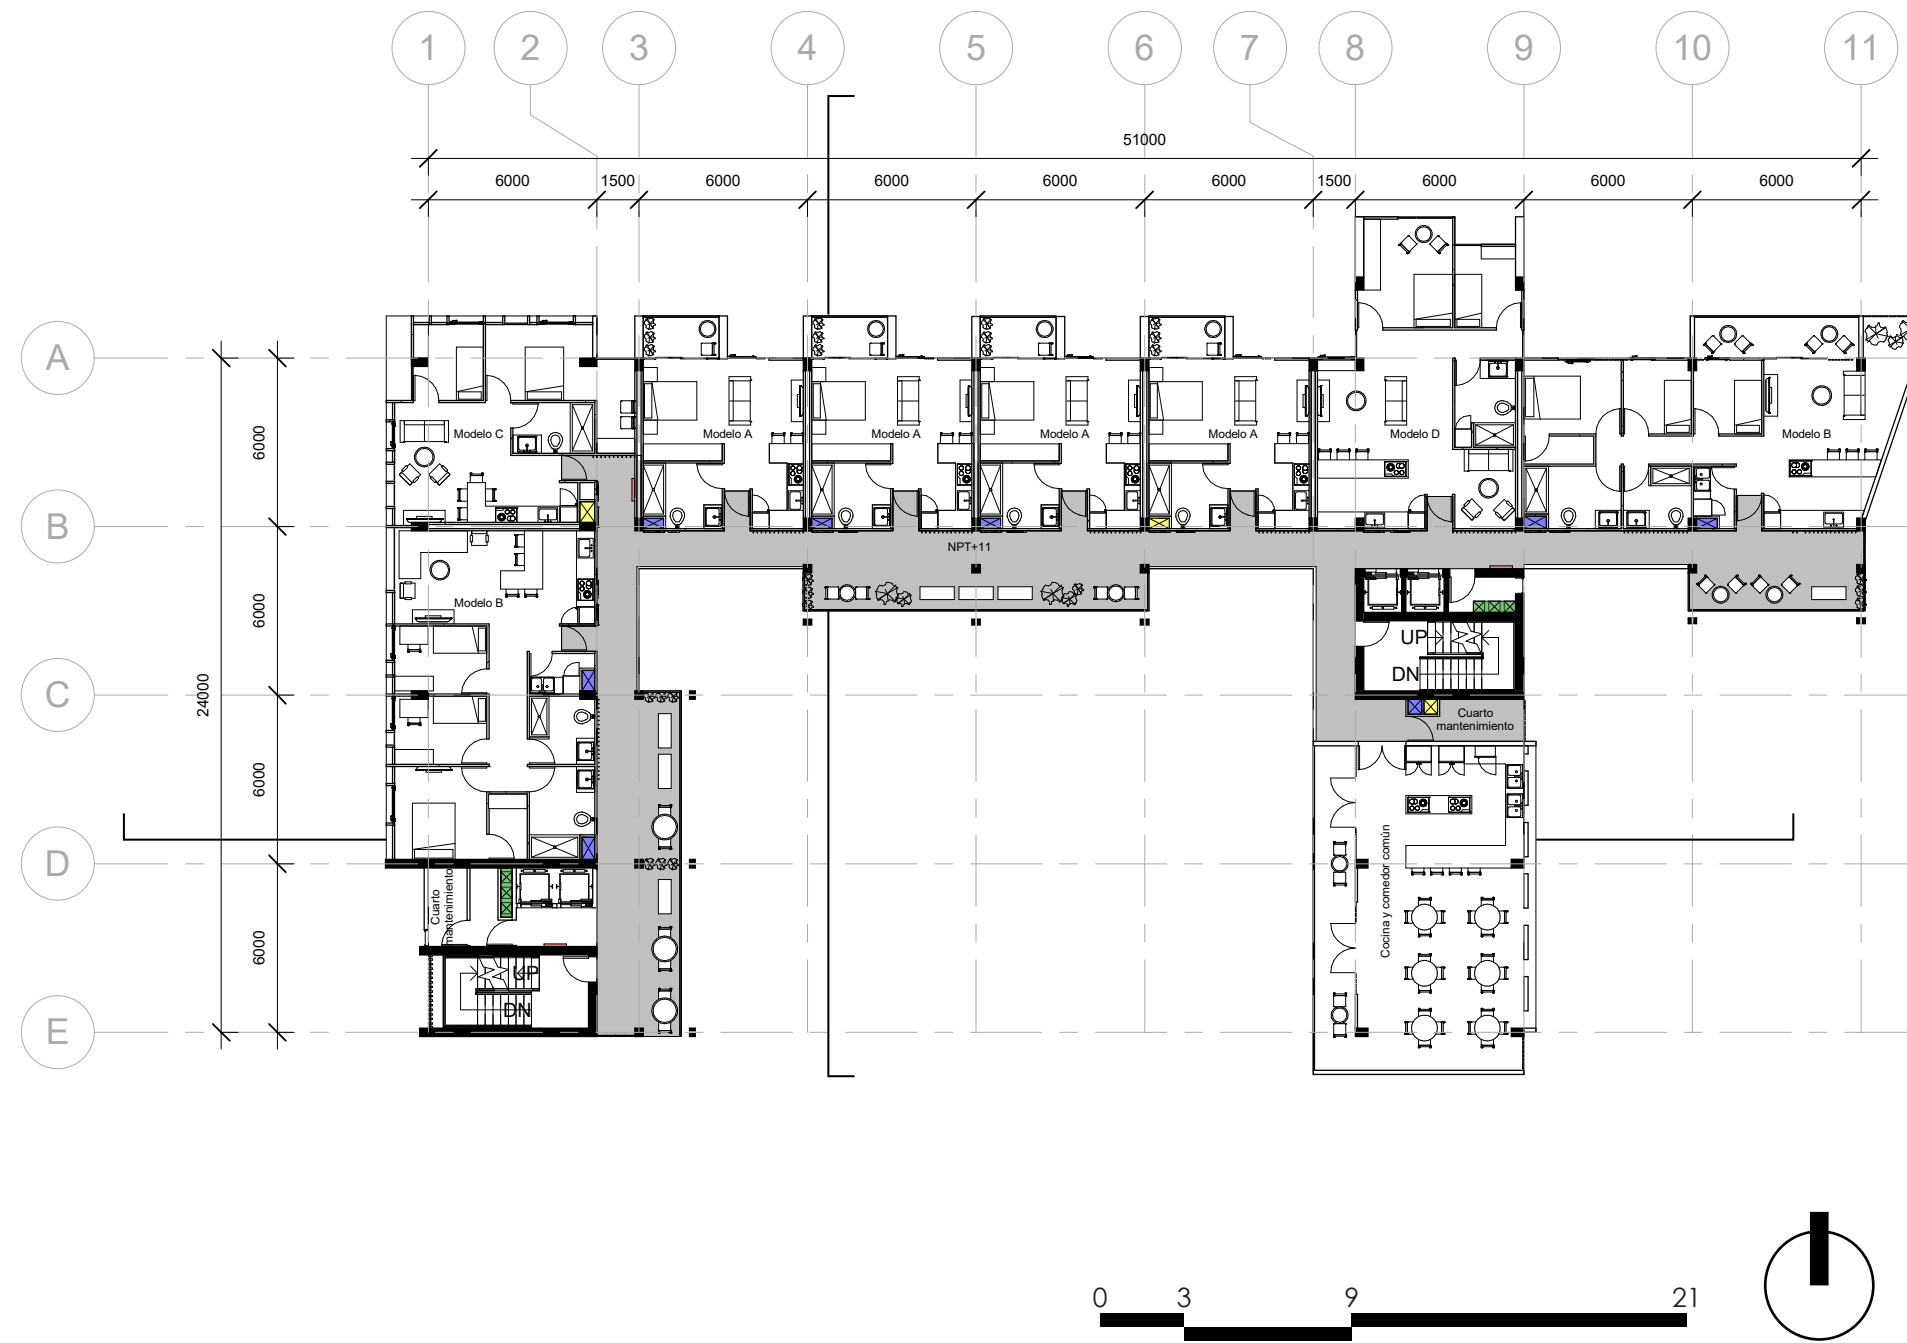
Planta nivel 3. Fuente: Elaboración propia.
